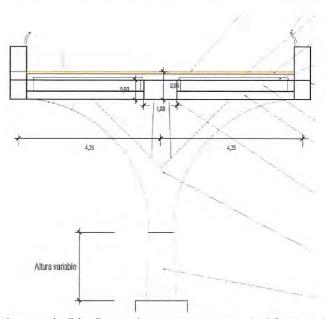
Columna de "dos" ramales con apoyo central formando un tridente.
